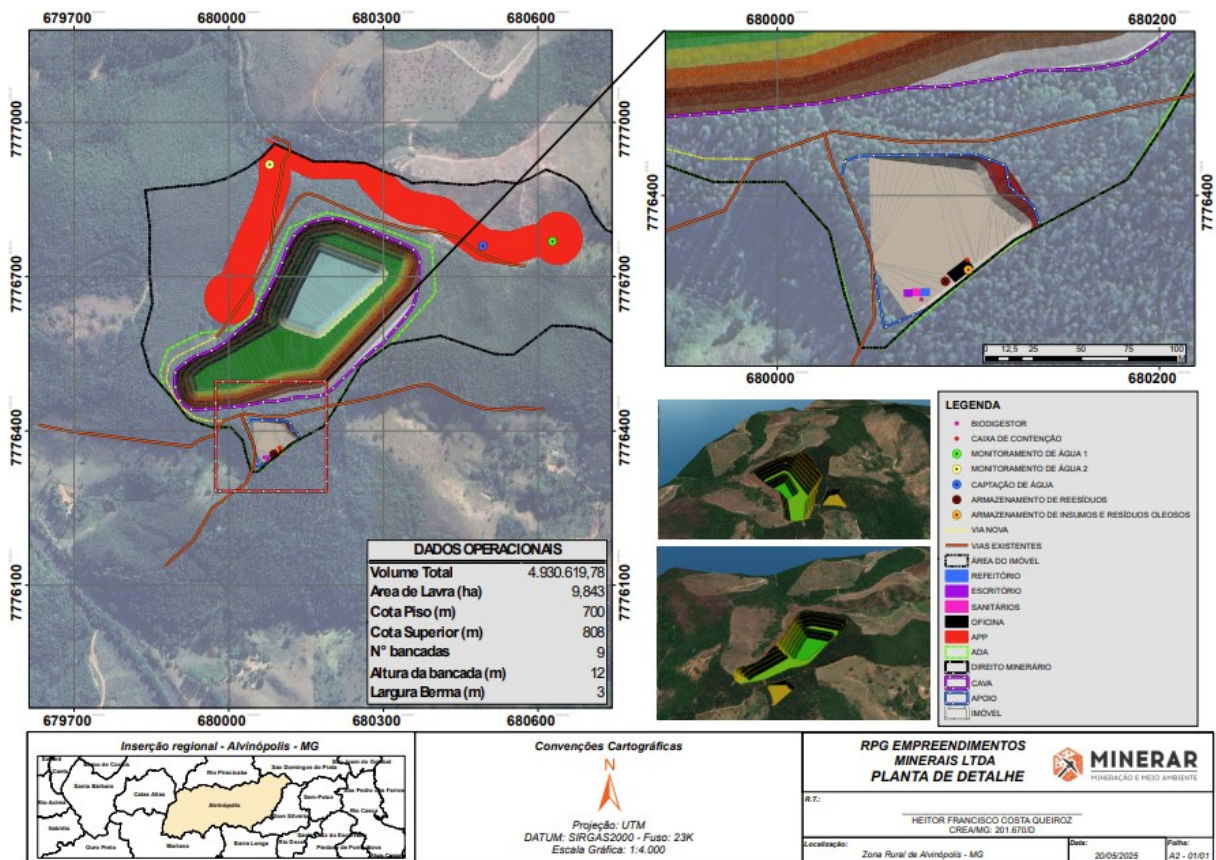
Planta detalhe. Fonte: Autos do P.A SLA n. 1289/2024.
